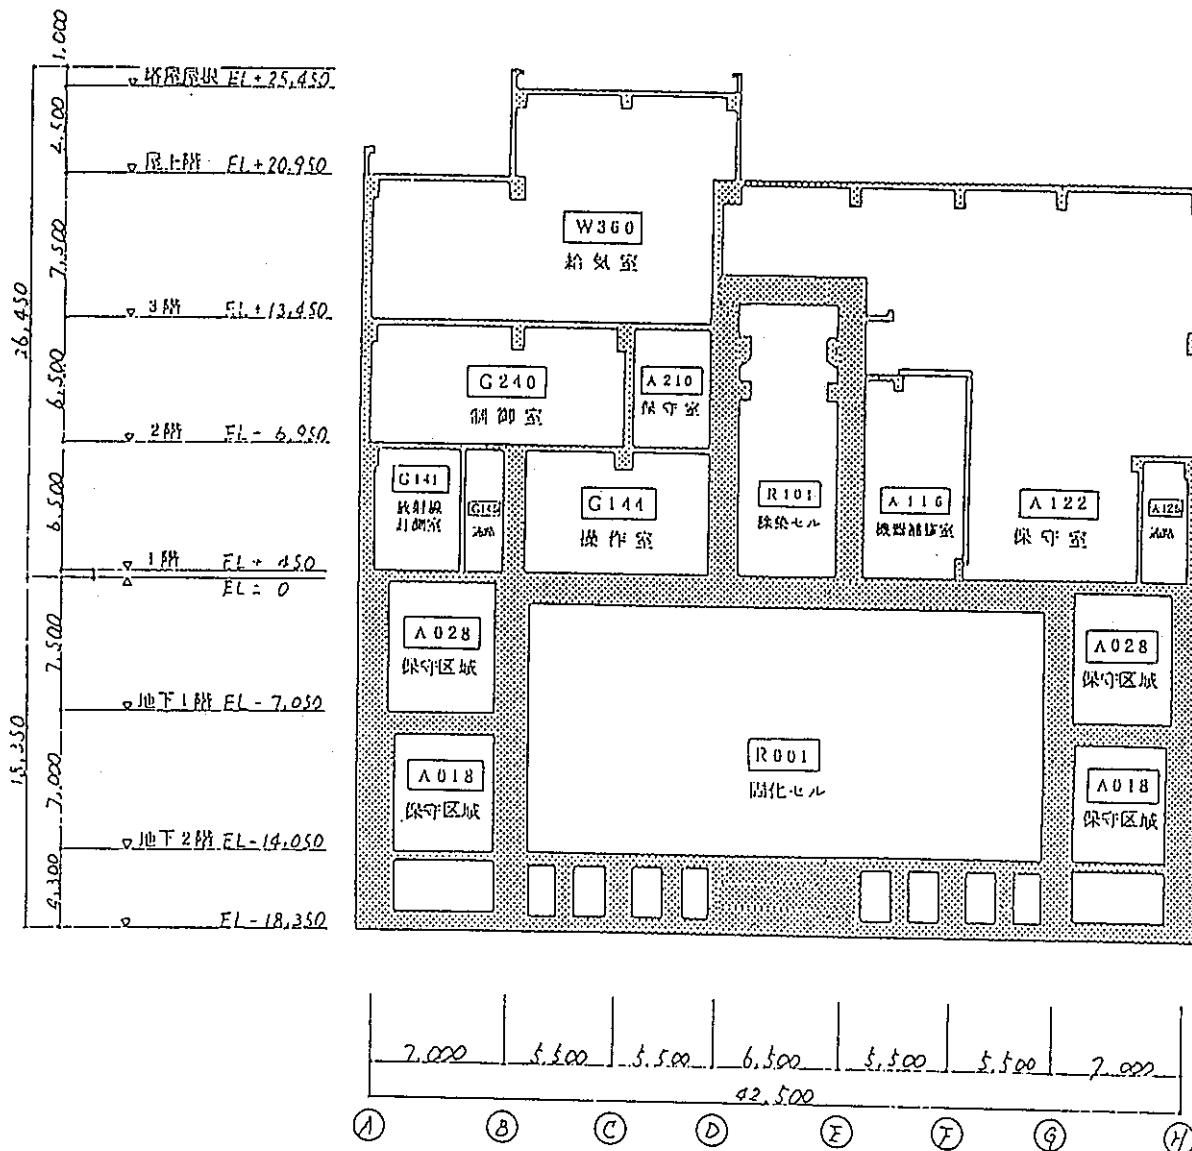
ガラス固化技術開発棟 断面図(4)
